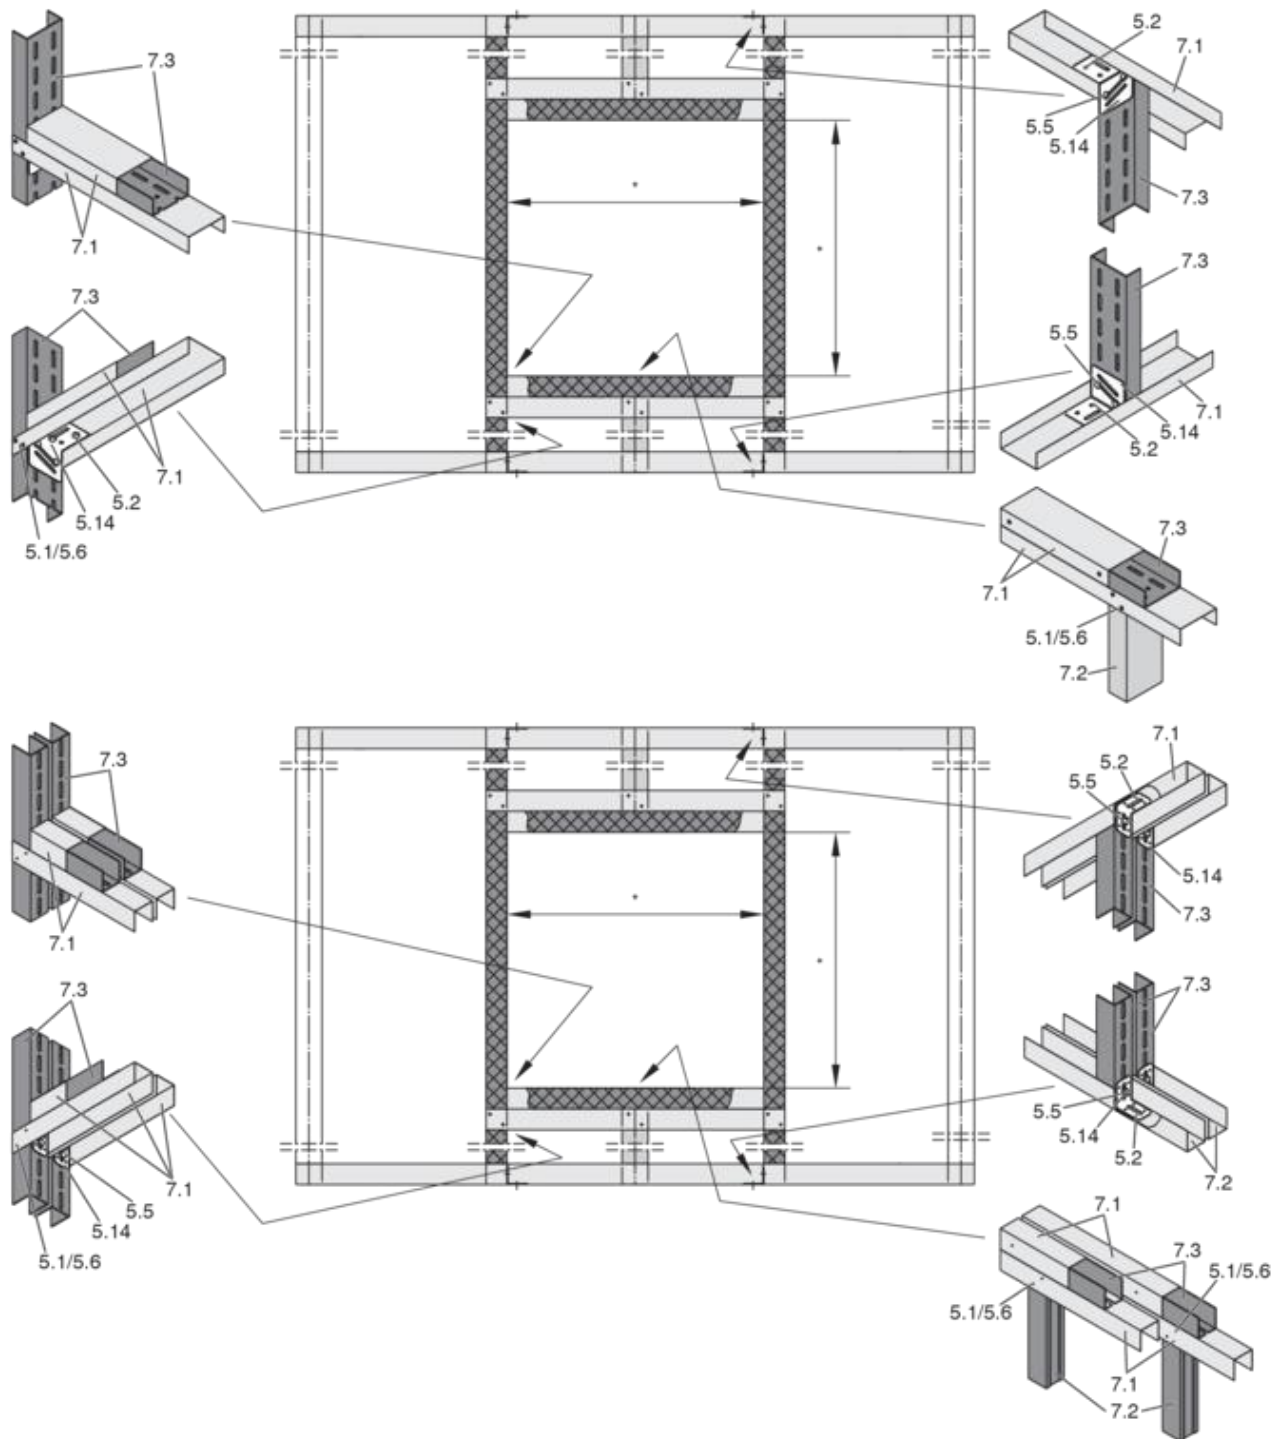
Metallständerwerk Brandwand, einfache und doppelte Ausführung
